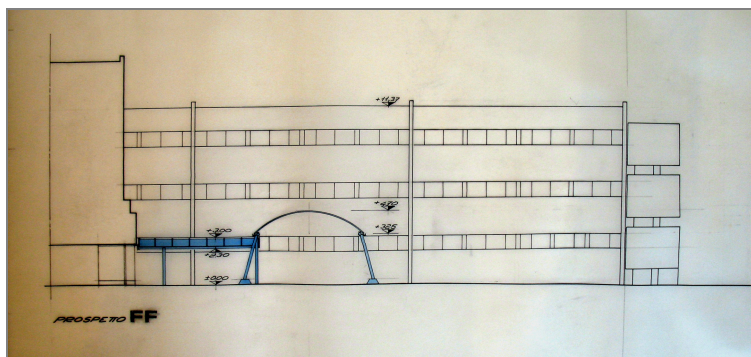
prospetto nord ovest corpo C (fonte CSAC – stralcio tav. 2, archivio n. 400-1)
